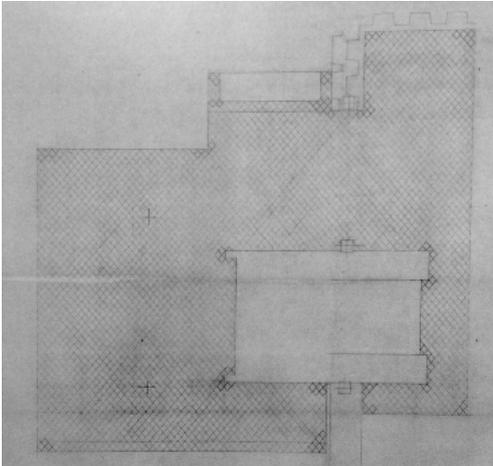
Detalle de una zona del pavimento cerámico a 45° de la planta primera.
